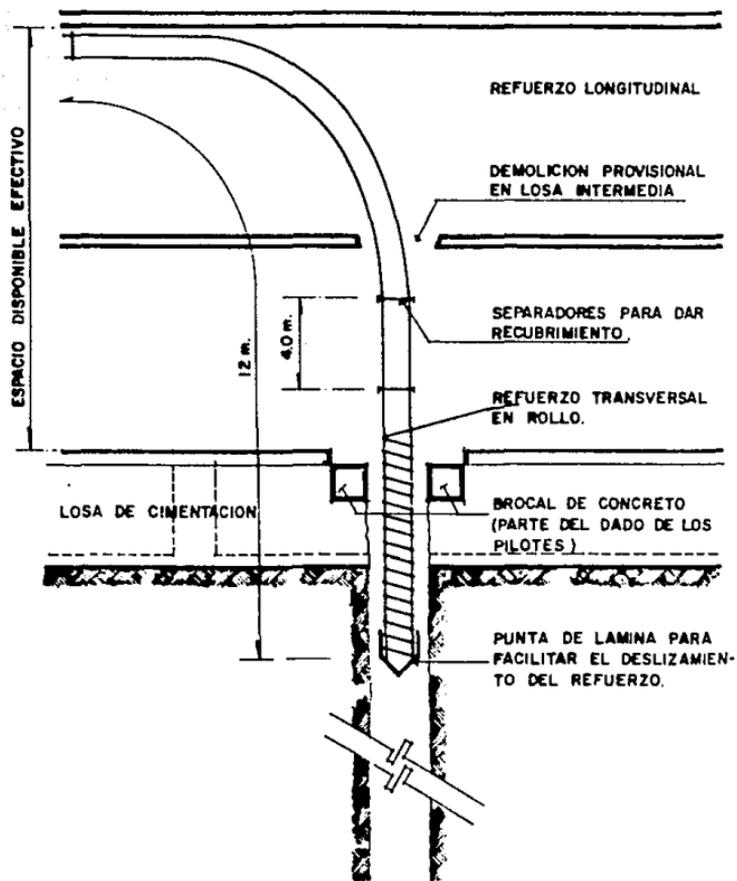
SECUENCIA DE ARMADO DE PILOTES COLADOS EN EL SITIO.
